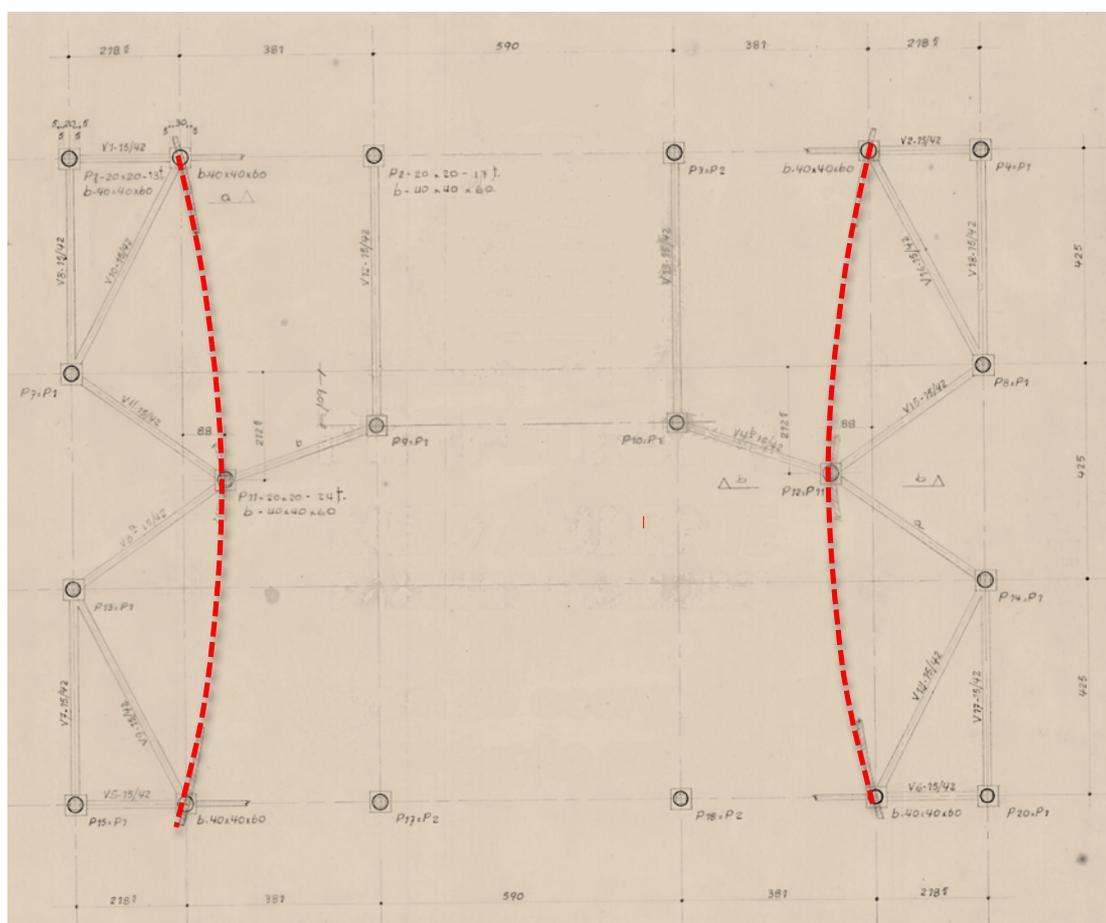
Desenhos de fundação do Pavilhão do Flamengo. Pode se observar o apoio dos muros unicamente em três pontos
